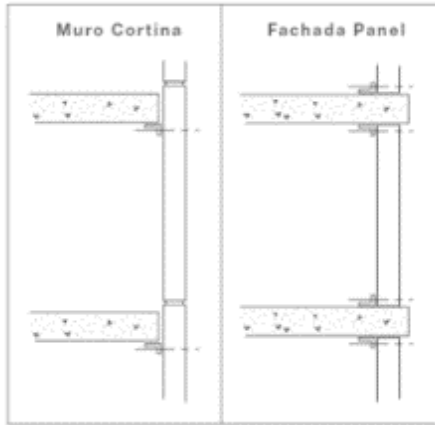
Sistema muro cortina y sistema fachada panel. Fuente: Extralum (2019)
